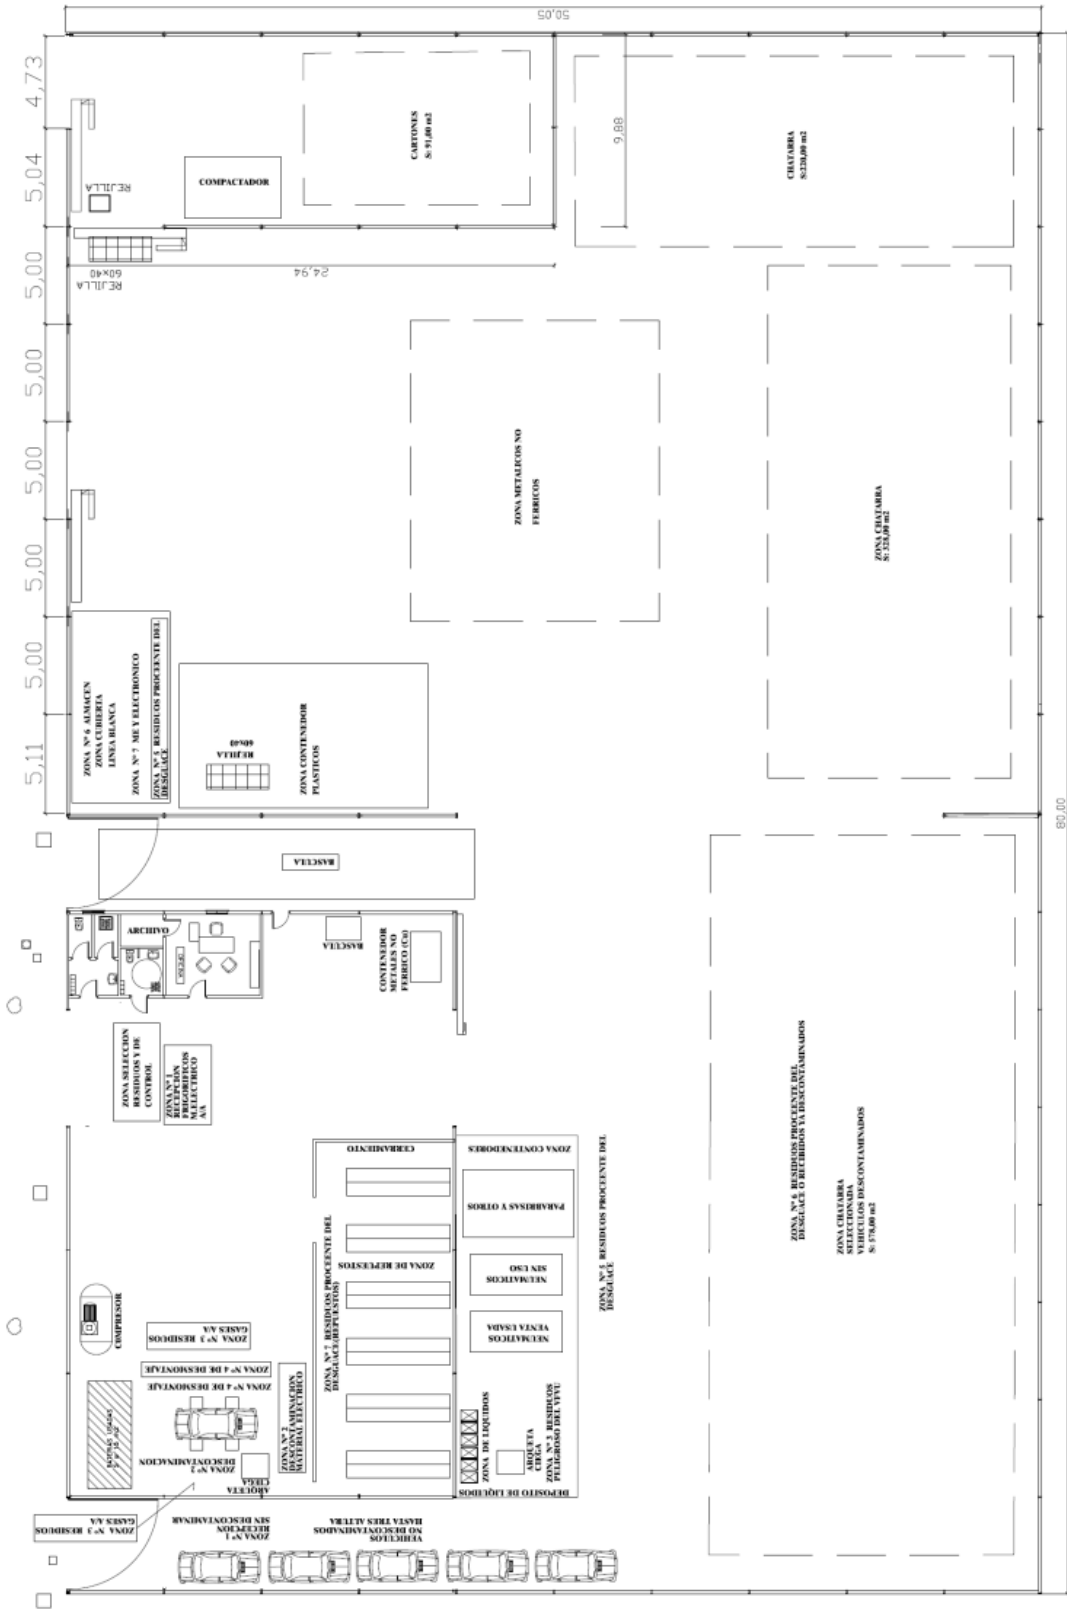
Plano en planta de la instalación industrial en el que se muestran los usos.
